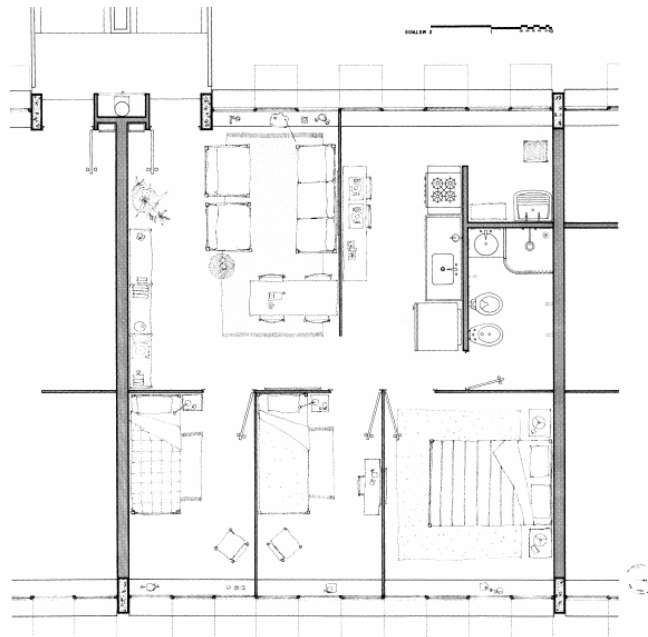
Planta Apartamento Tipo - CECAP Zezinho Magalhães Prado, Guarulhos/SP Planta flexível - Possibilidade de Layout Interno
